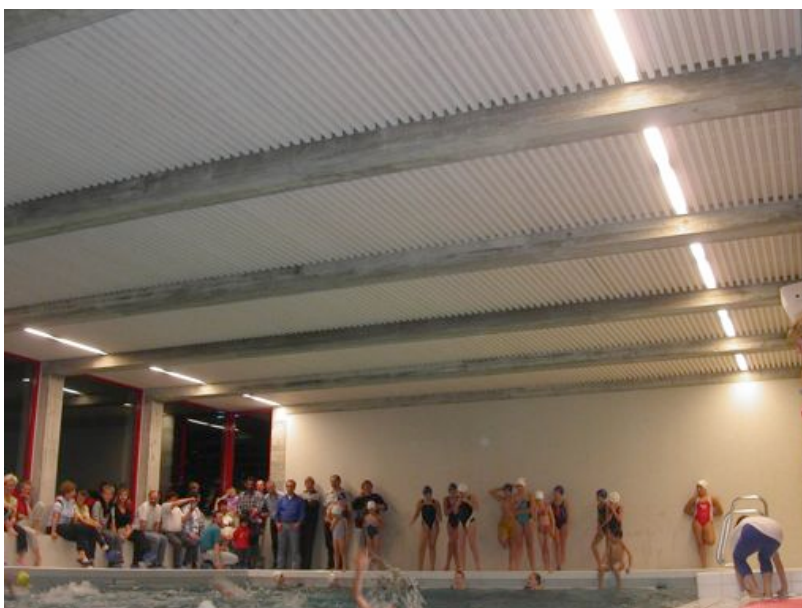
Bäretswil: Sanierte Decke im Schulbad.
